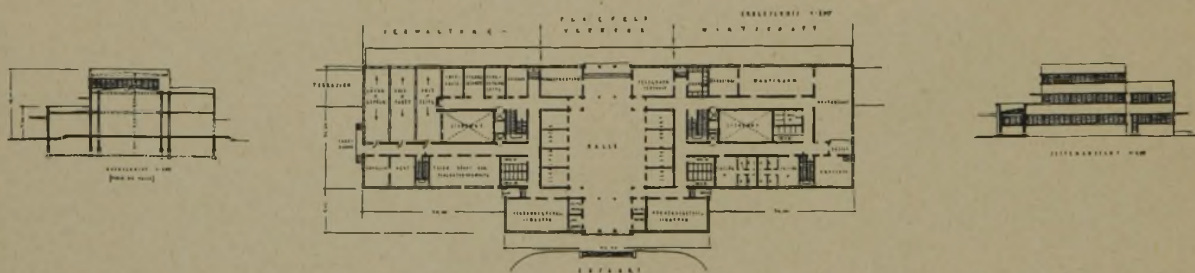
Grundriß, Schnitt und Seitenansicht des Verwaltungsgebäudes (rd. 1 : 1600).
